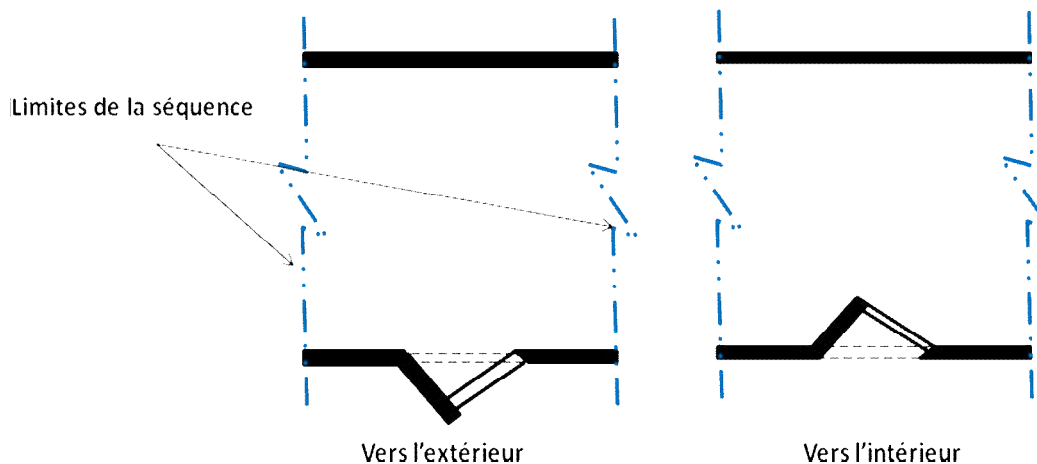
L'inclinaison de la baie par rapport au plan.
